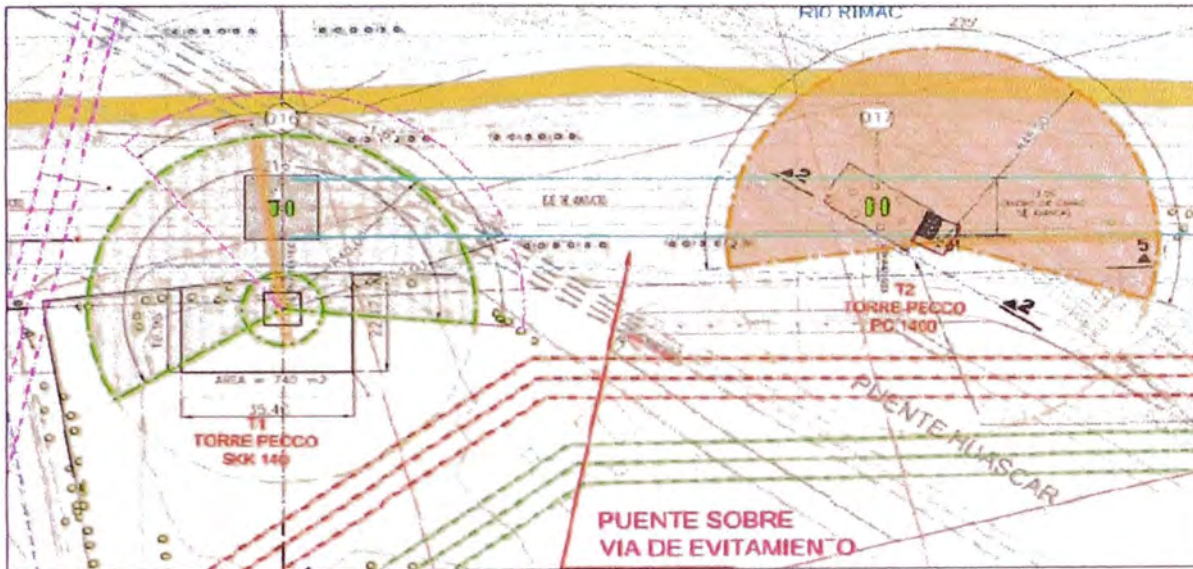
Ubicación de las Torres Grúa - Planta
